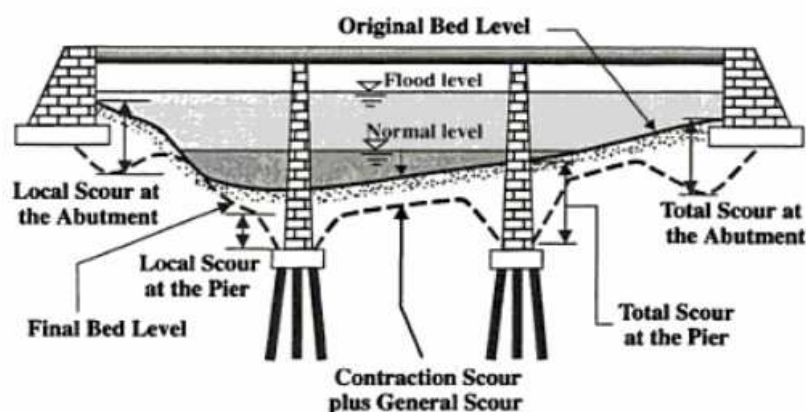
Tipos de erosión en puentes (Melville y Coleman, 2000)
